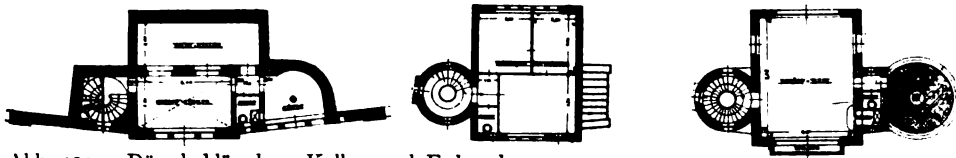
Düsselschlösschen. Keller- und Erdgeschoss. 1:500.
